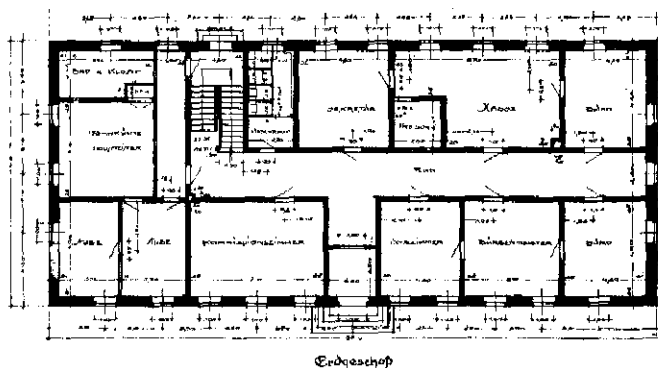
und 5 / Schülerarbeiten der Staatlichen Bauschule in Gotha / Entwurf zu einem Rathaus / Grundrisse 1:400
